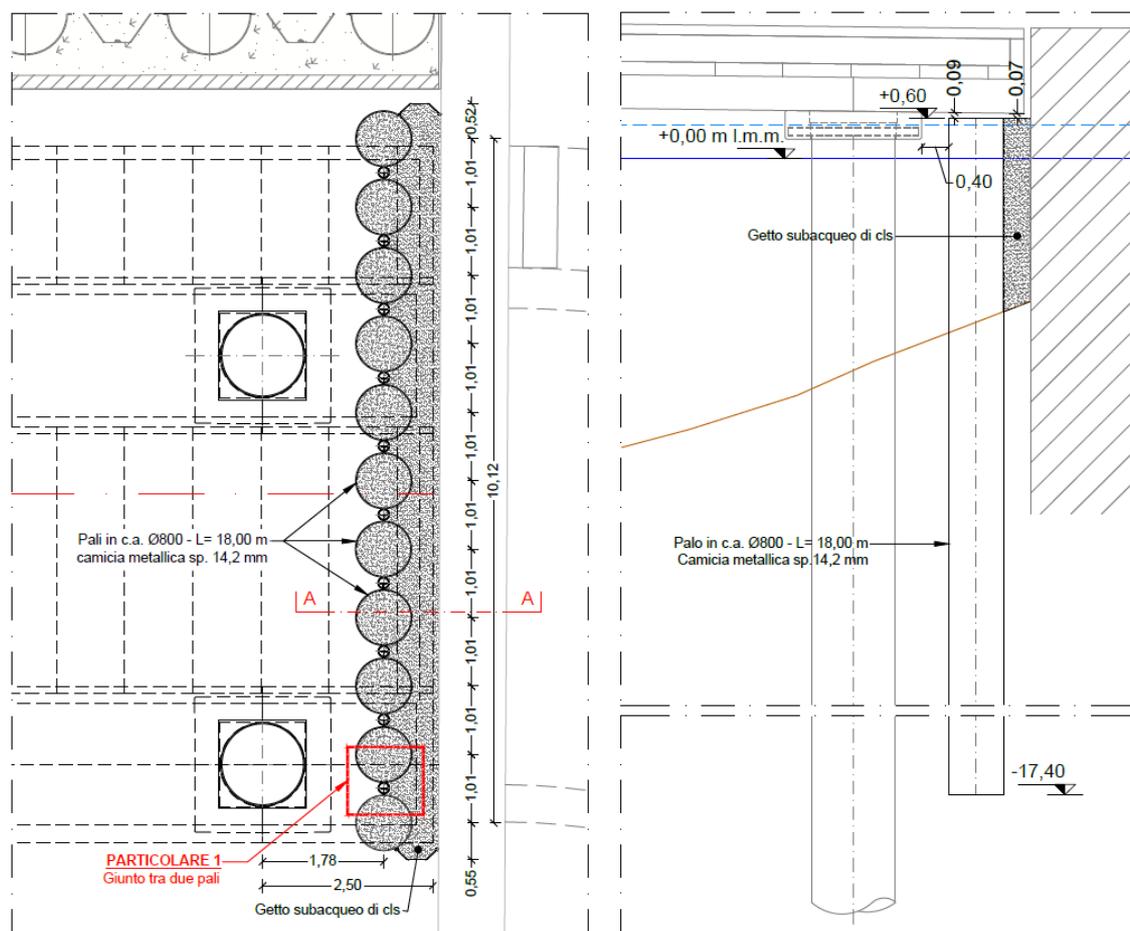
Consolidamento Banchina molo Nord: planimetria e sezione
